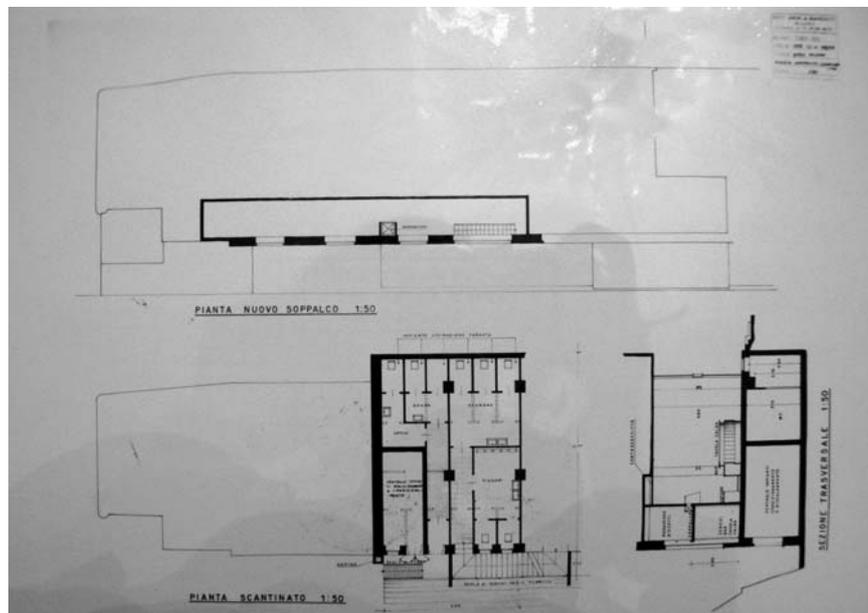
Pianta del piano seminterrato e del mezzanino (AAB)
